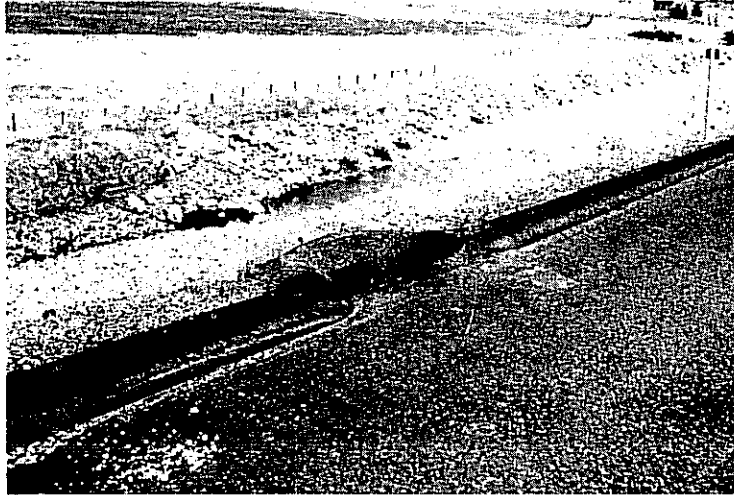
Reborde lateral dirigido hacia una zanja pavimentada
